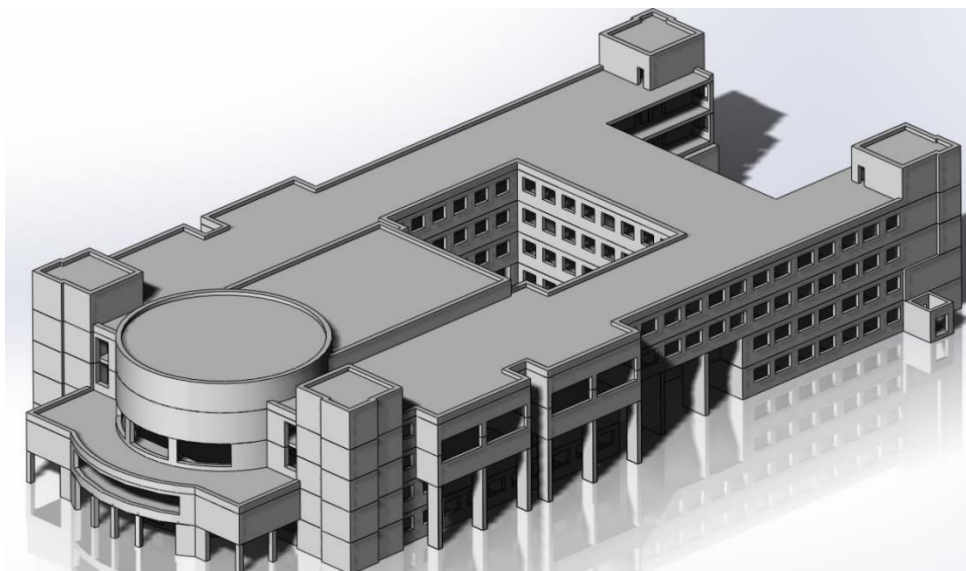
Вид сборки трехмерной модели третьего учебного корпуса.
